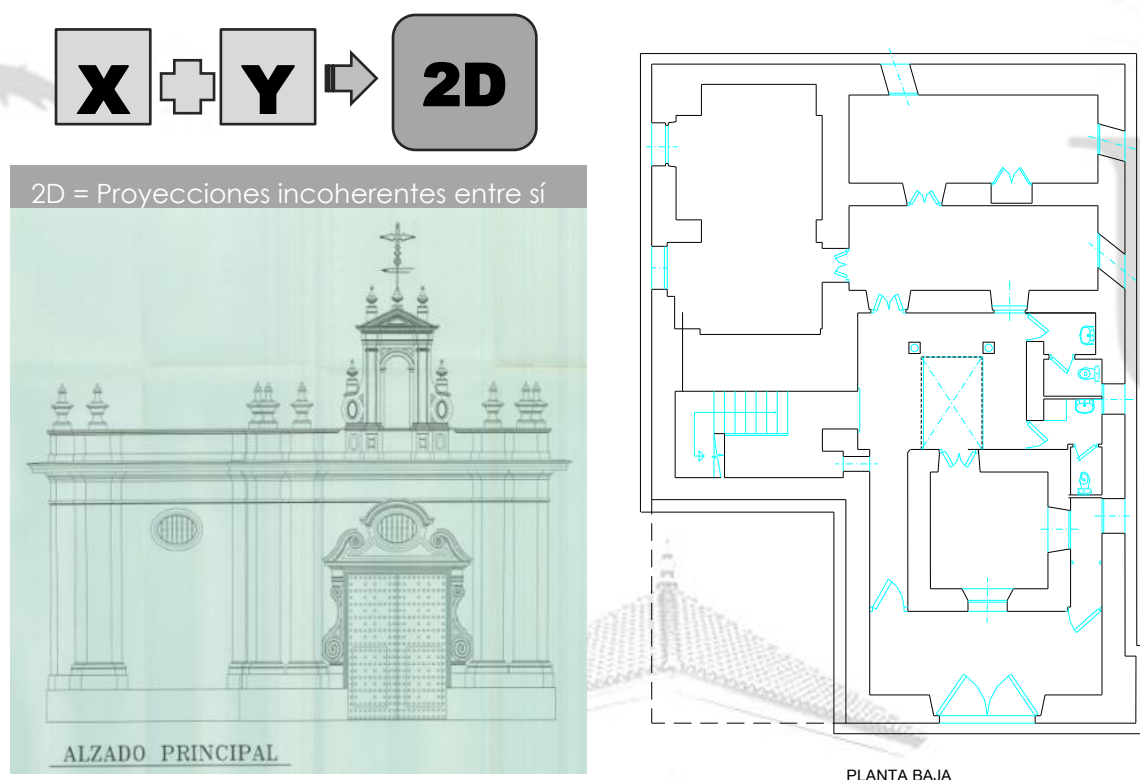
a) Alzado de la fachada principal insertado en la planimetría; b) Planta en 2D en formato digital dwg. Ambas realizadas con AutoCAD. Cárcel de la R.F. Tabacos de Sevilla, Documentación del TFM. 2010.
